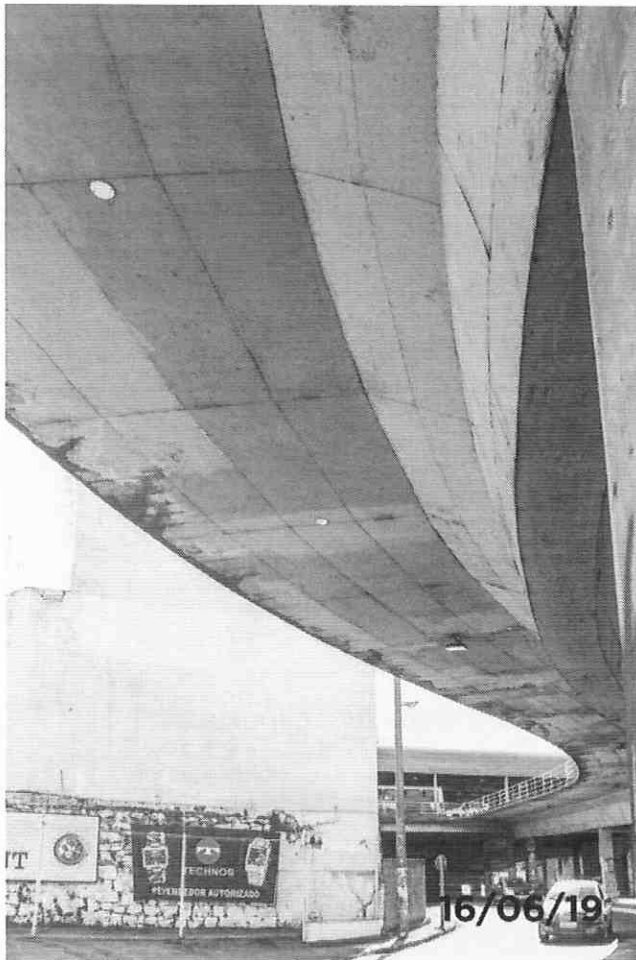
Vista geral frontal inferior da Passarela, detalhe ausência de pingadeira laterais, processo de infiltração e armaduras expostas.
